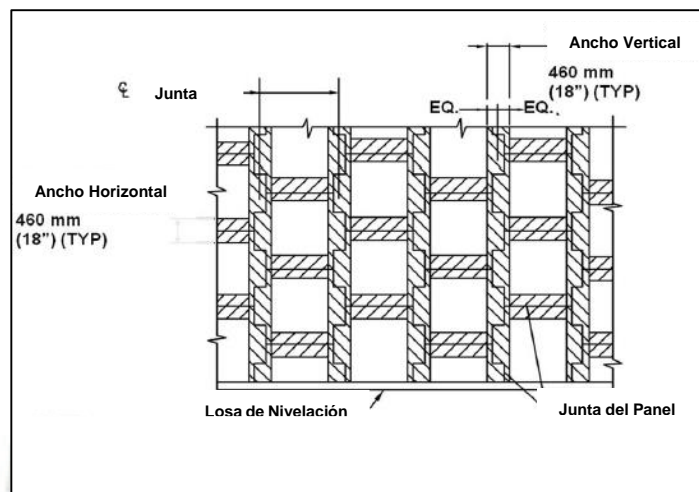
Geotextil en las juntas entre paneles segmentados (FHWA-NHI-10-024, 2009)
